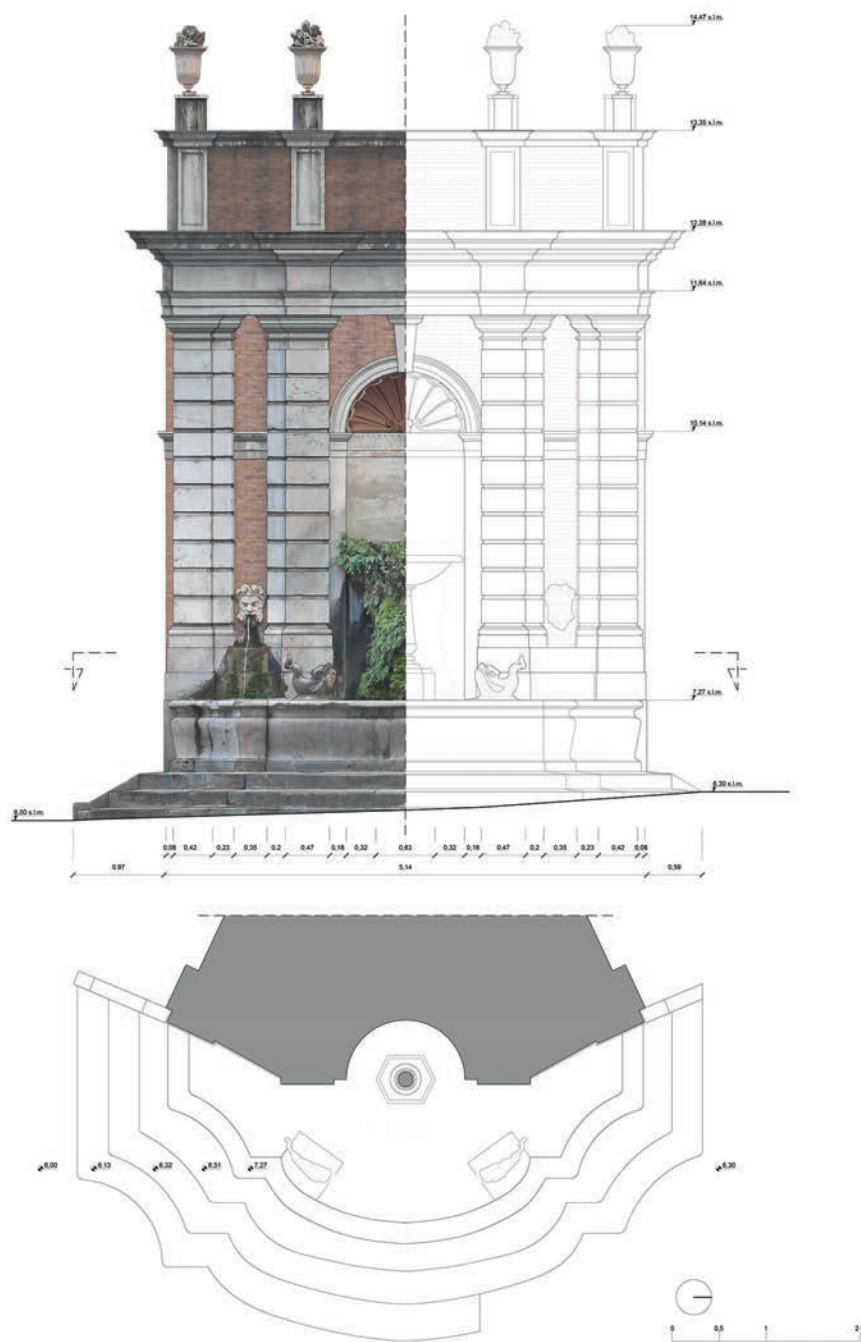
Pianta e prospetto ricavate dall'ortofoto della 'fontana dei pesci' di Salerno.
